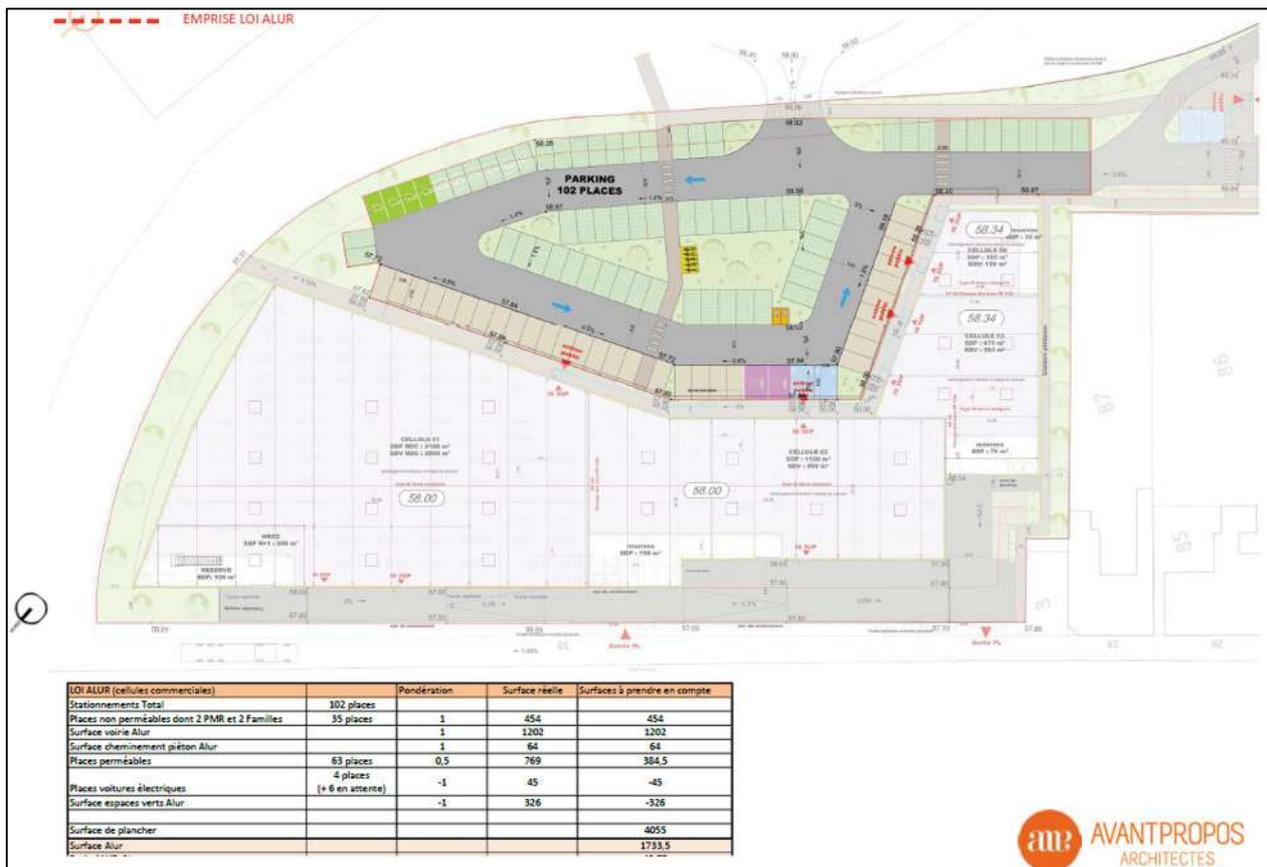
Plan des stationnements Loi ALUR (source : AVENTIM)
